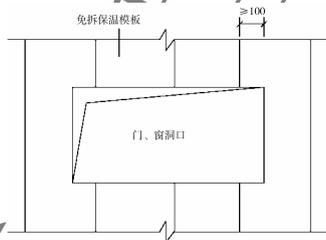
现浇混凝土免拆模板门窗洞口处模板排版构造要求
